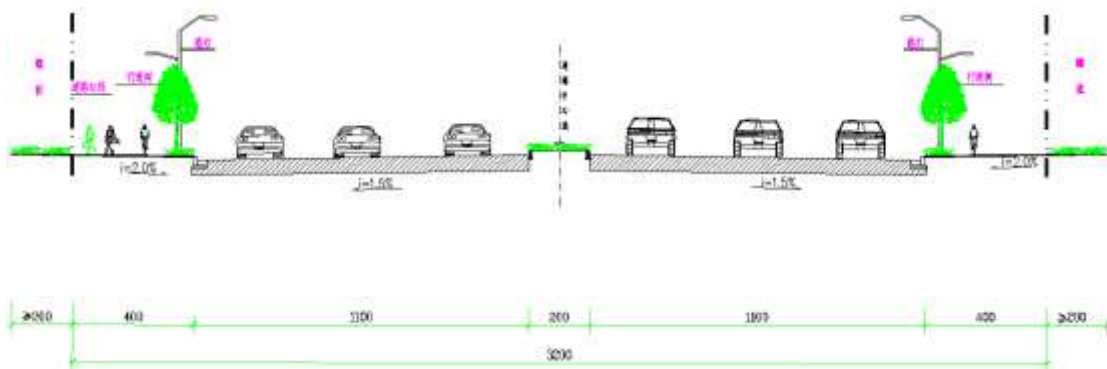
32 米宽道路标准断面图（单位：cm）
